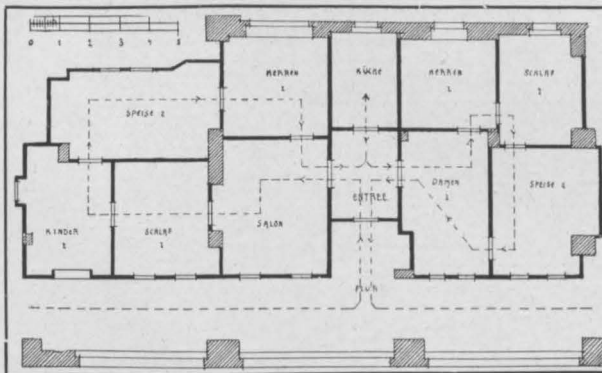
Grundriß der Wohnungsausstellung bei Wertheim-Berlin, Leipziger Straße.
